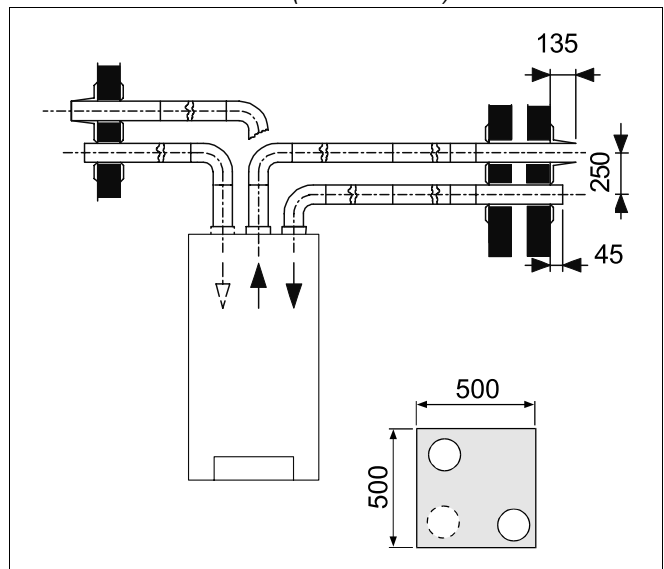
Alimentazione diretta dell'aria attraverso la parete esterna e convogliamento dei fumi di scarico attraverso la parete esterna stessa (misure in mm)
